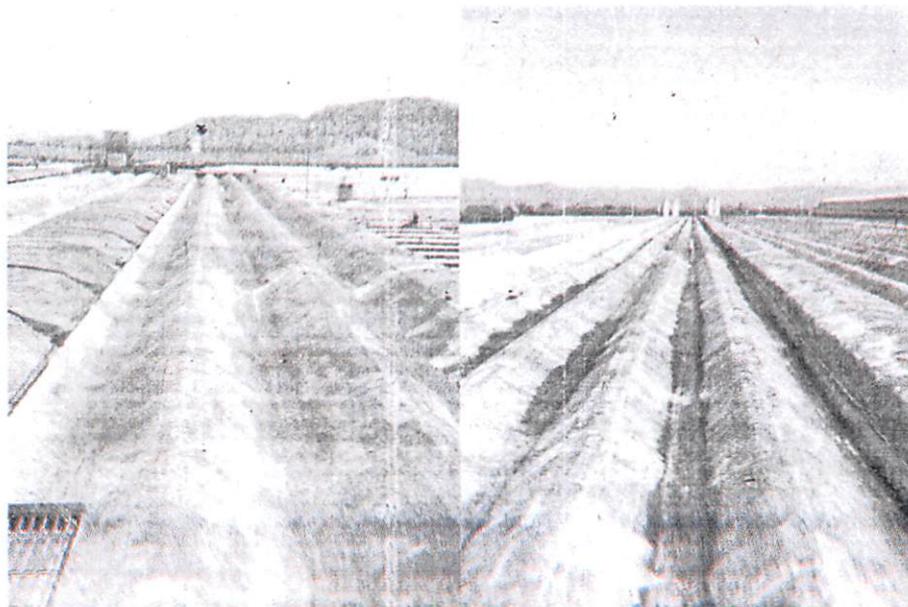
Vista geral do telhado do super mercado = telha tipo canaletão, com a vigas calhas para a coleta e condução das águas pluviais.
